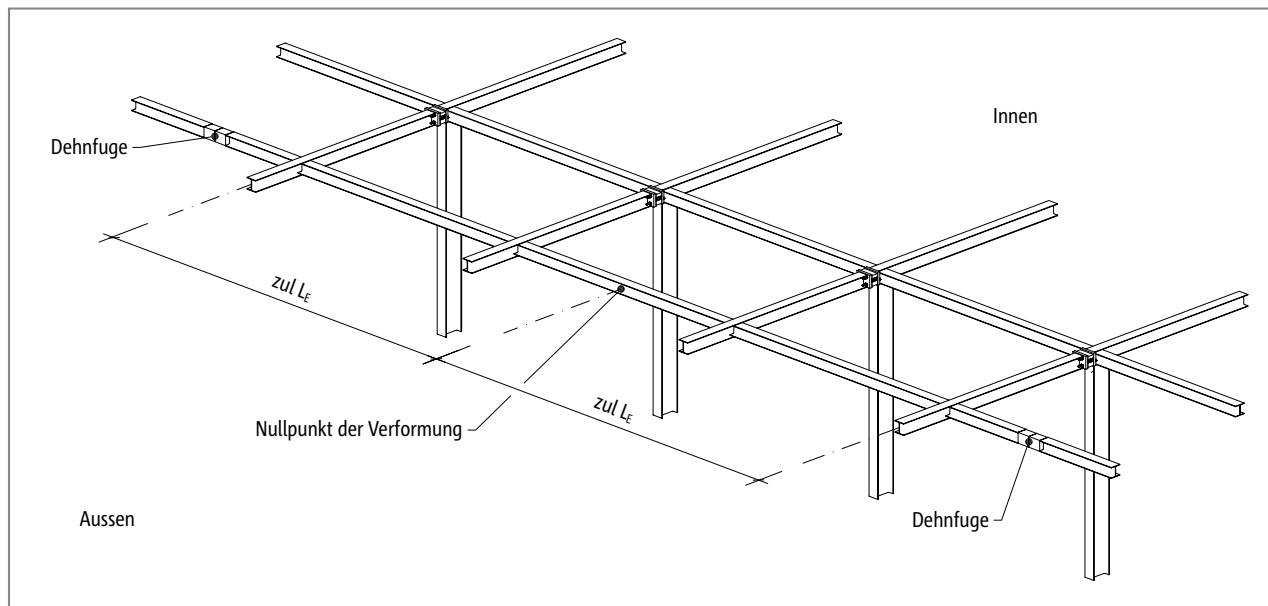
Schöck Isokorb® T Typ S: Lasteinflusslänge der äusseren Konstruktion, die durch Temperaturdehnung beansprucht wird
